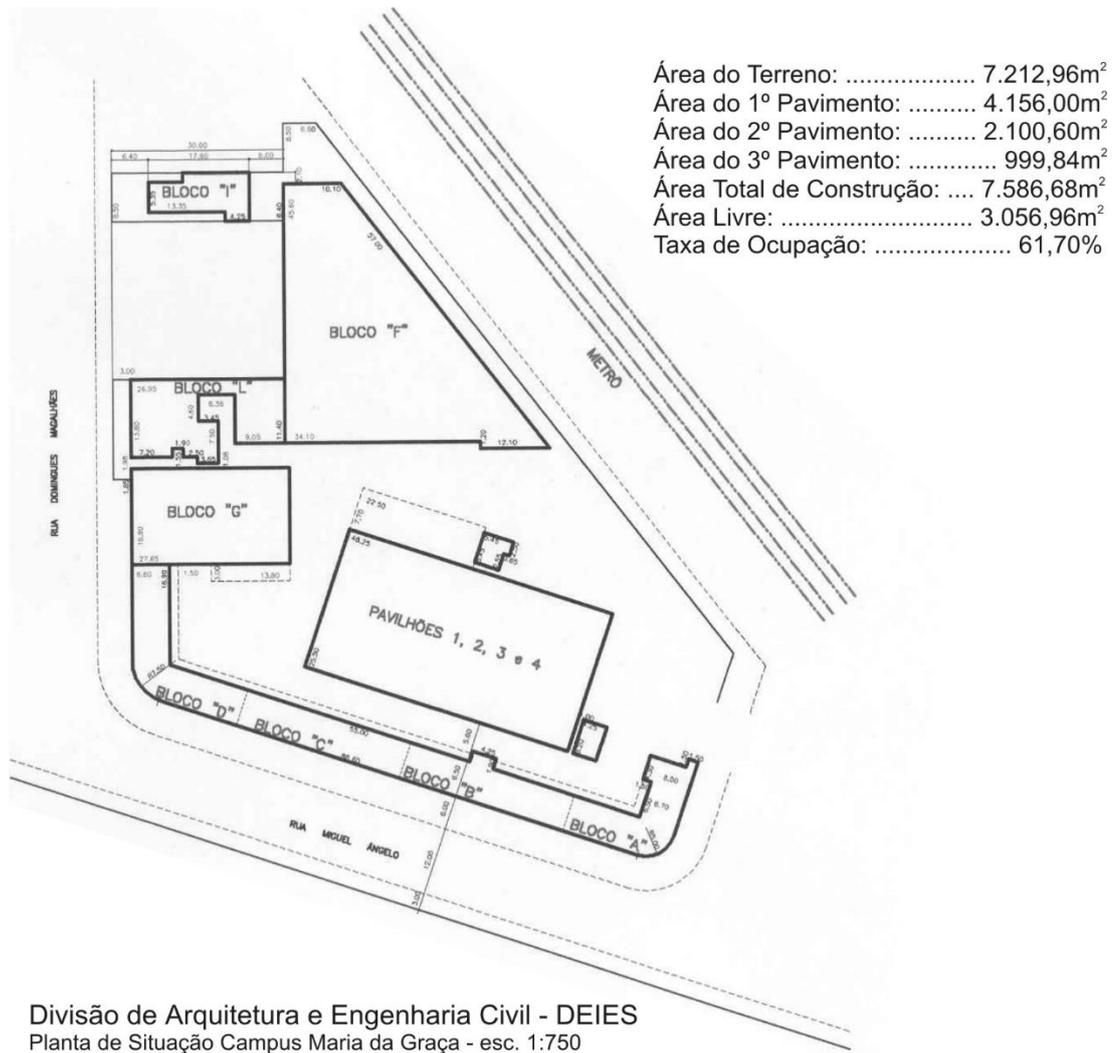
Planta de situação da UnED Maria da Graça - CEFET-RJ.
